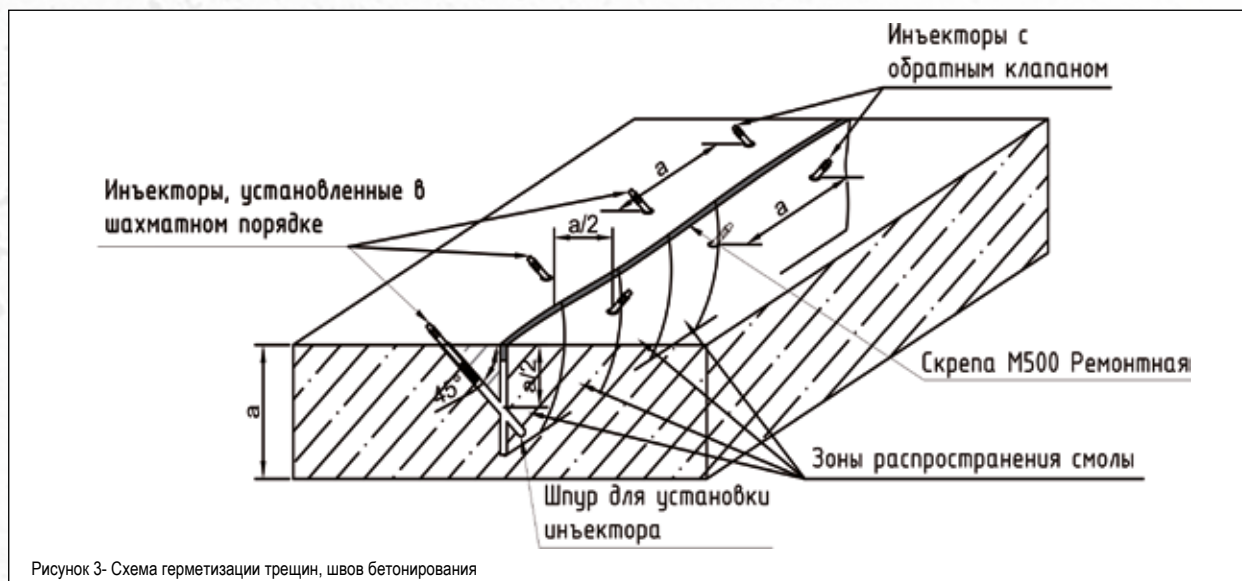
Схема герметизации трещин, швов бетонирования
